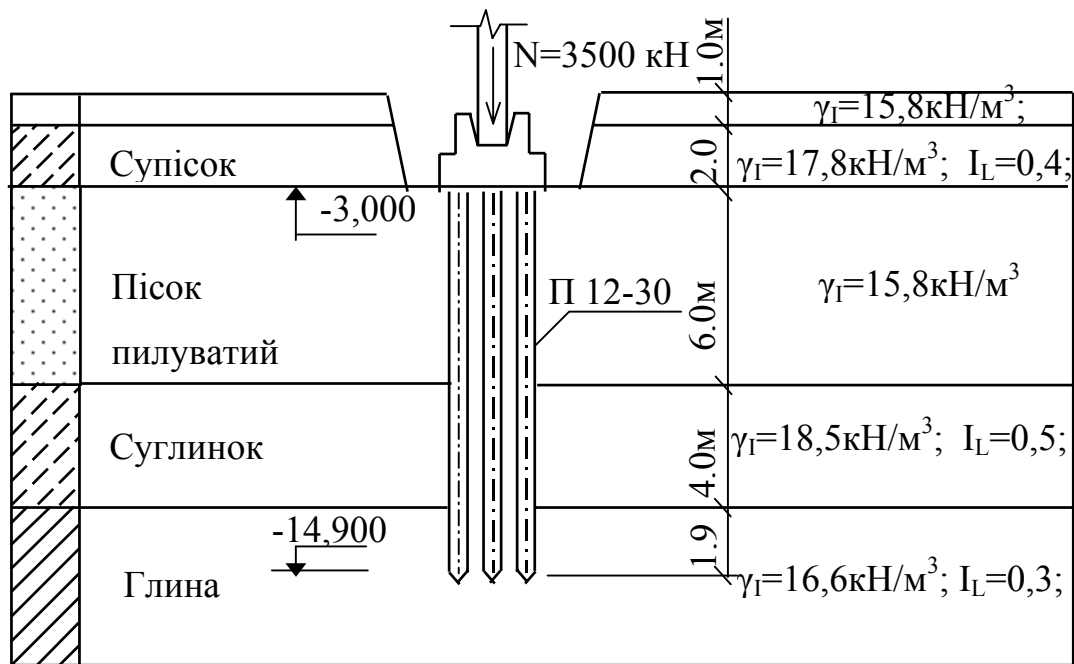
Схема розташування пального фундаменту у ґрунті
